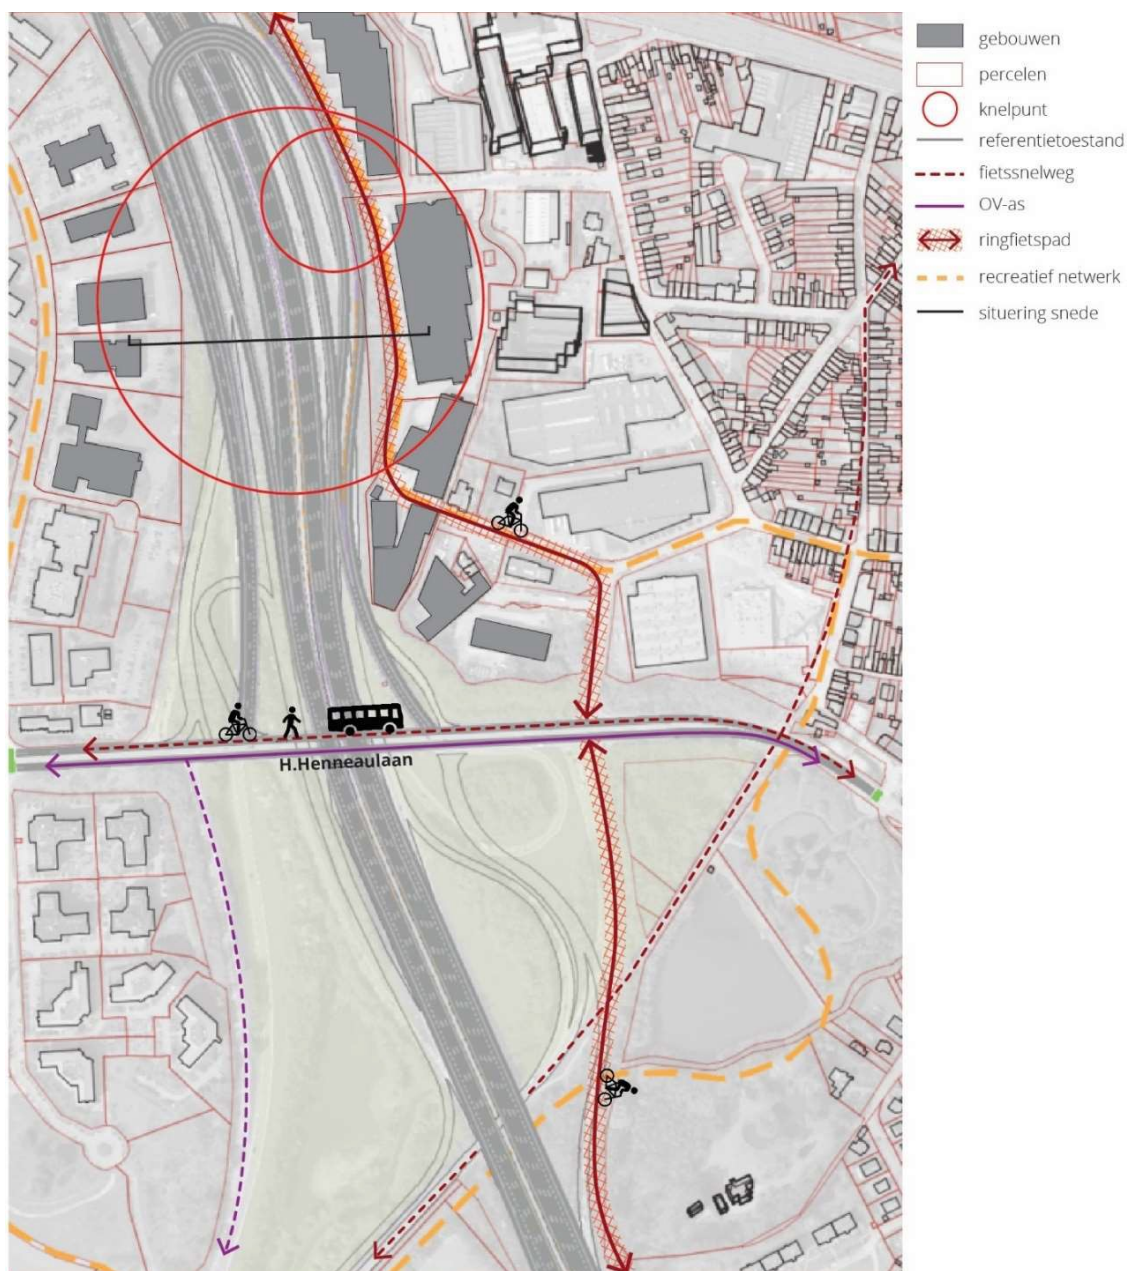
Plan G1A2 - Avenue Hector Henneau
